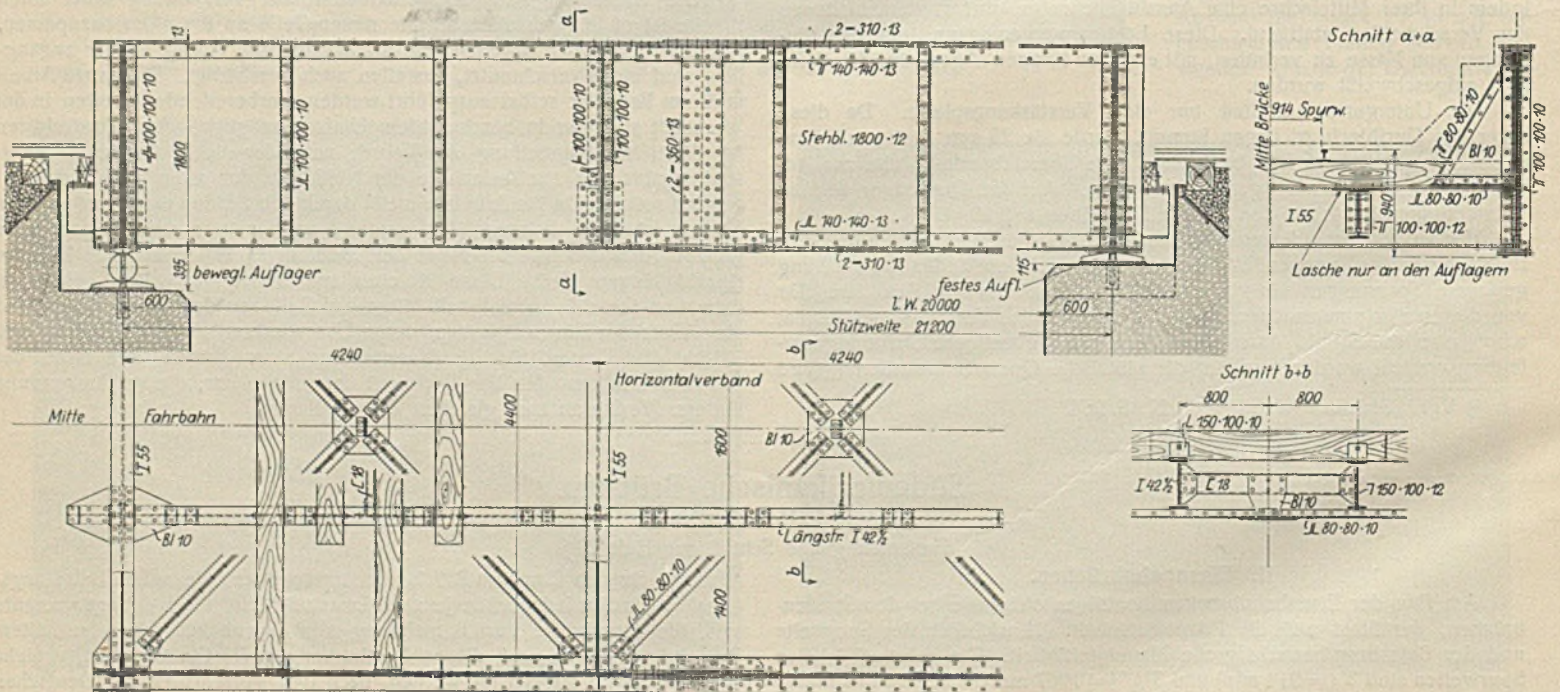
Eisenbahnbrücke mit beschränkter Bauhöhe.
